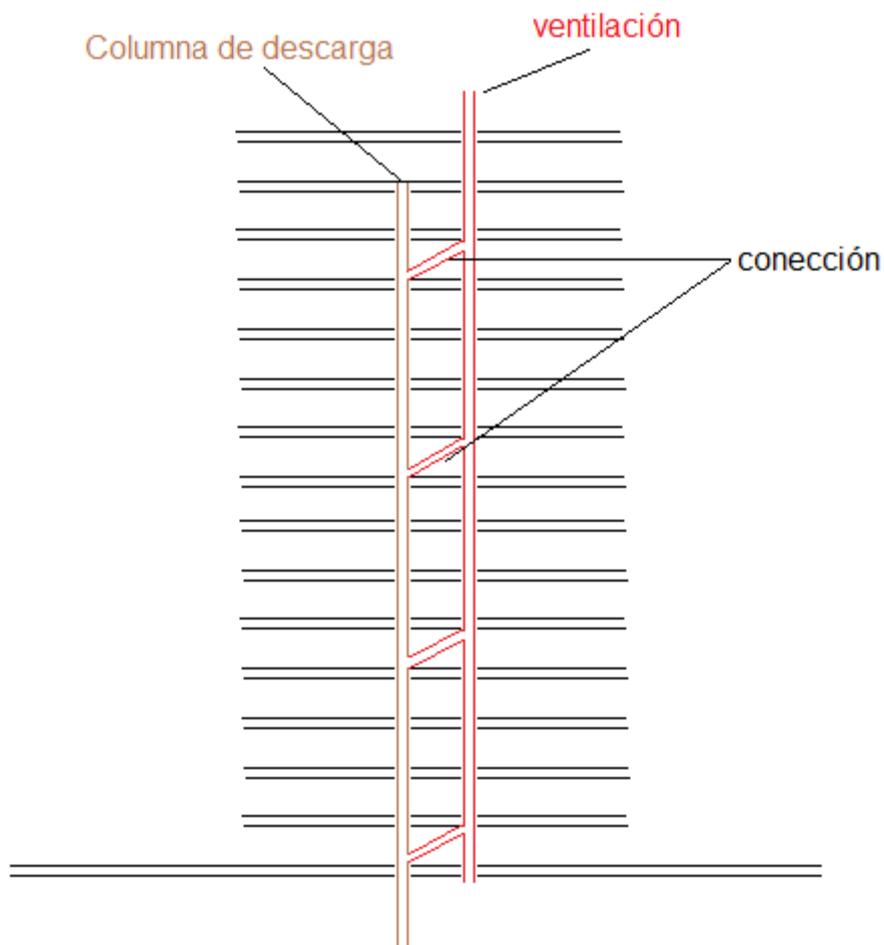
Conexión (por horquilla) entre una columna de ventilación paralela al bajante vertical de un edificio alto.
